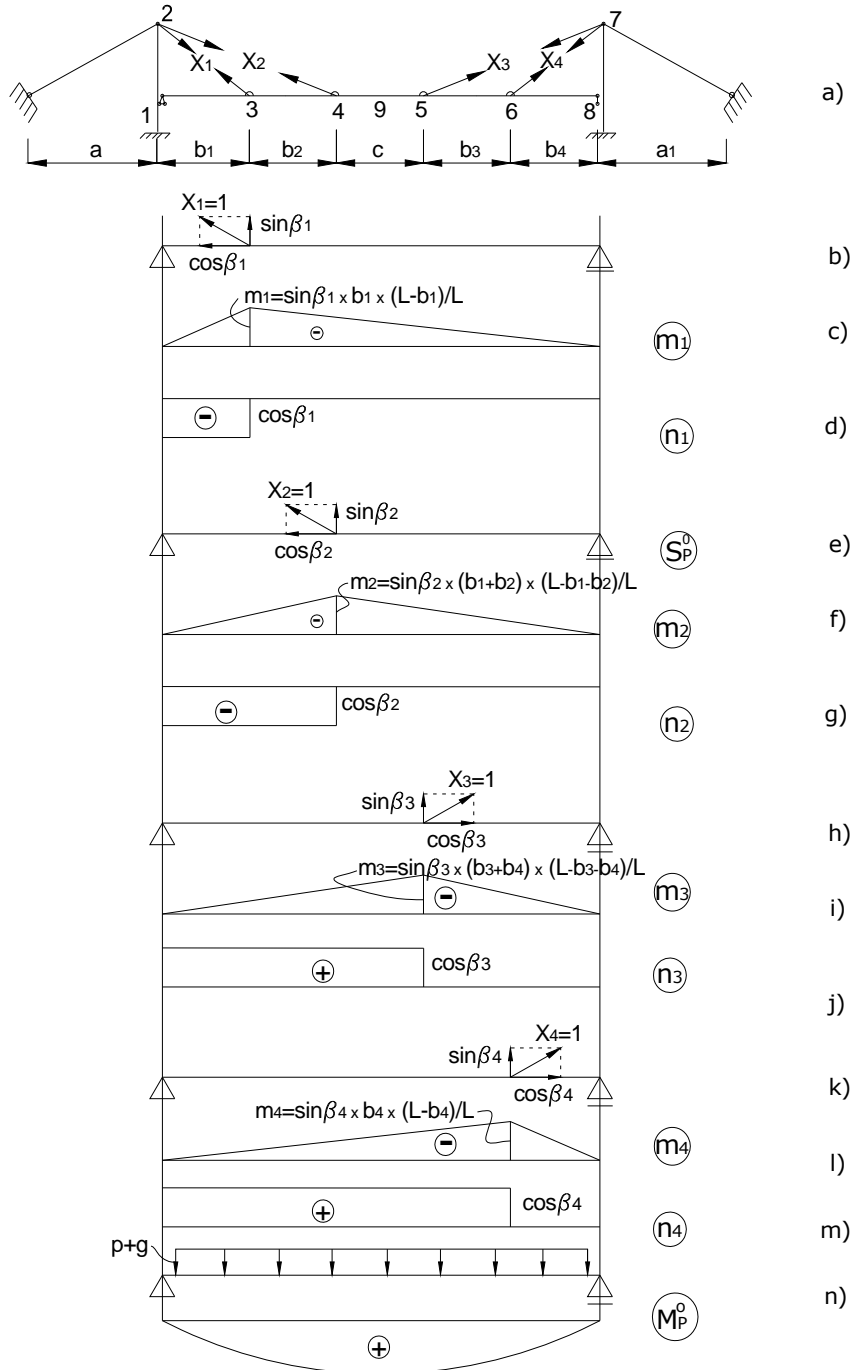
Structura de bază pentru traversare cu patru cabluri drepte
